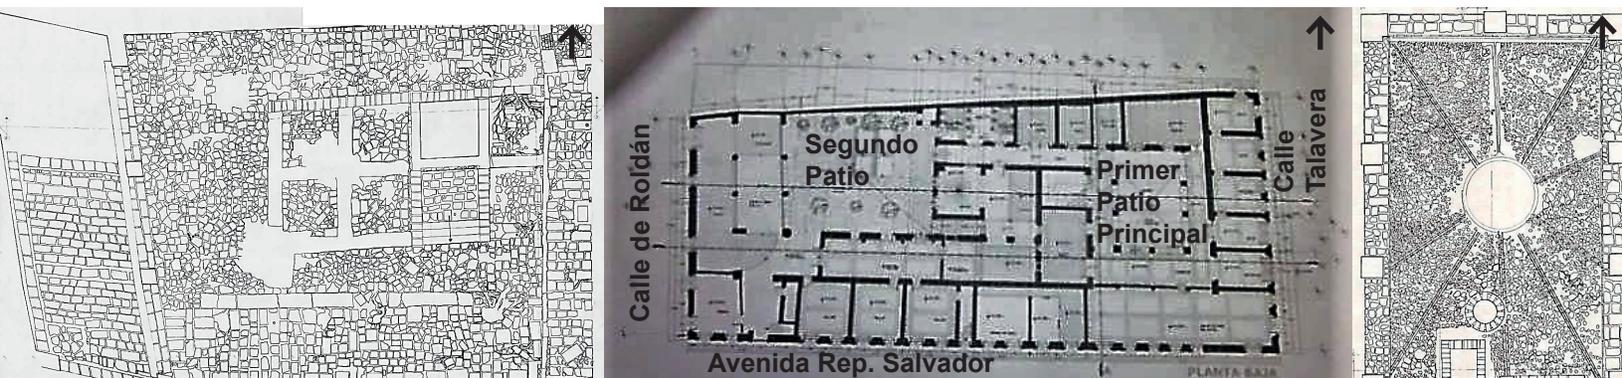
Planta arquitectónica de la planta baja de la Casa Talavera y los dos patios.
